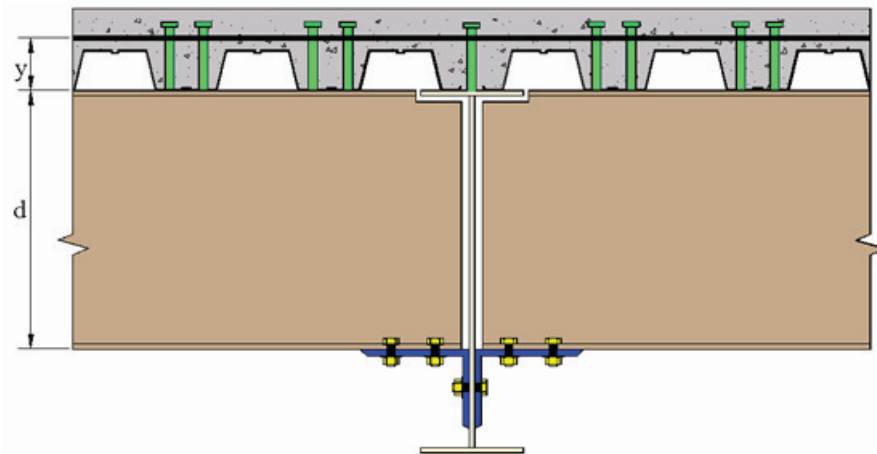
Ligações mistas com cantoneira de assento parafusada na mesa inferior da viga [MATA (2003)]
